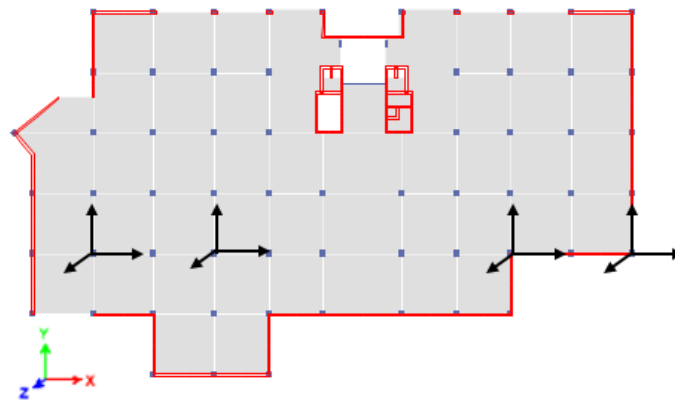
Esquema de ubicación de sensores en la Primera planta de la estructura. Instrumentación Tipo 4.
